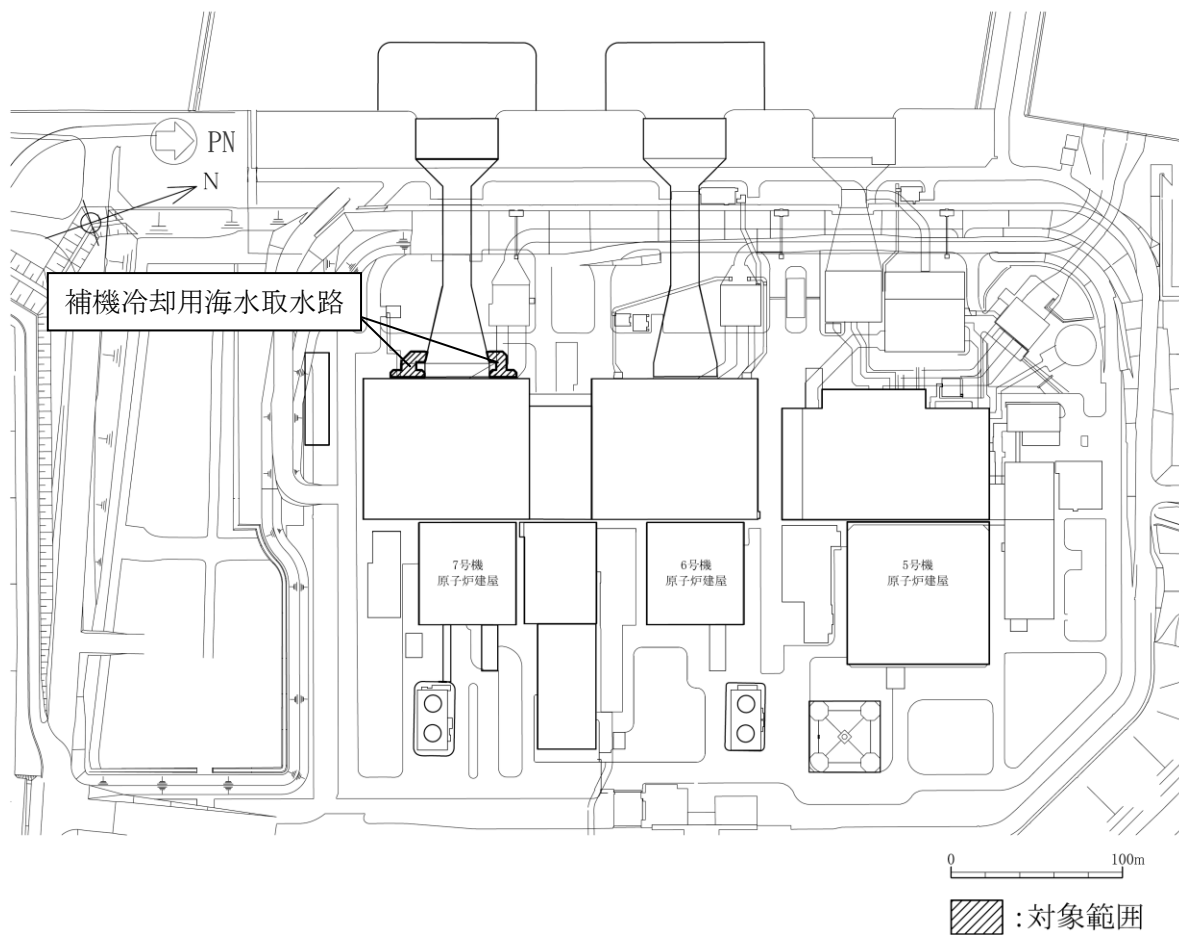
補機冷却用海水取水路の位置図（全体平面図）
